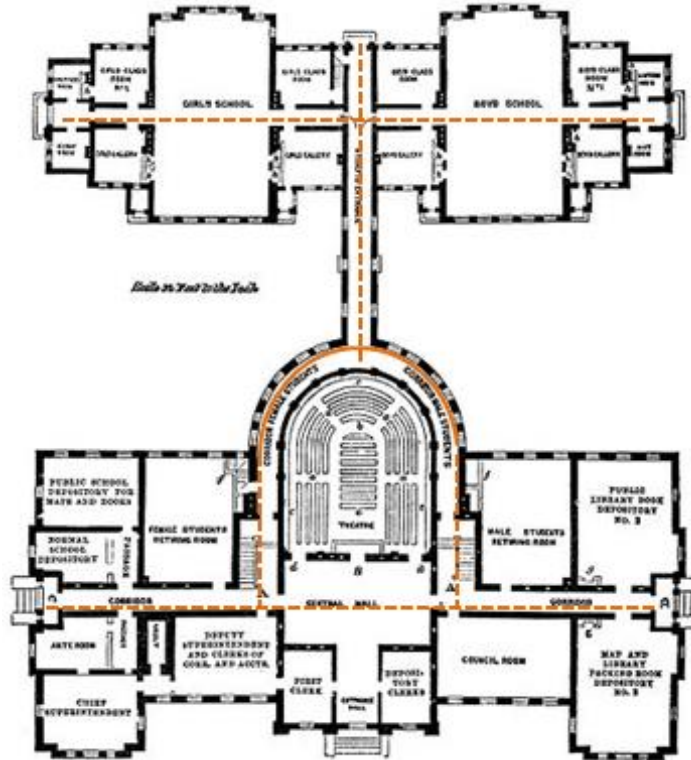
Planta Baixa da Escola NH, do início do século 19, em Dublin.
